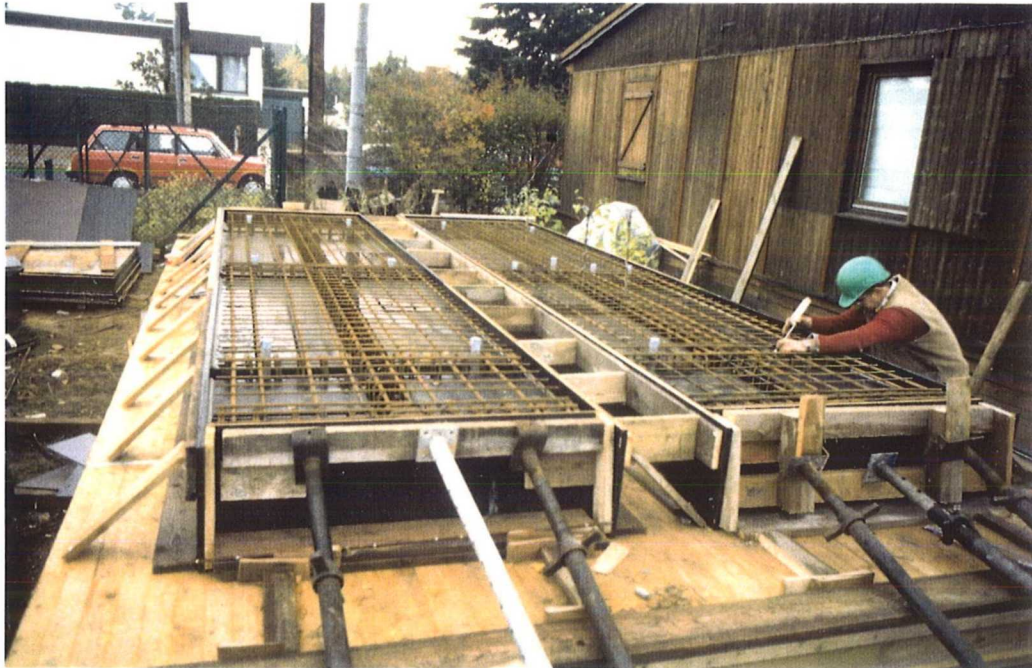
Fertige Bewehrung eines Trägerpaares vor dem Betonieren
